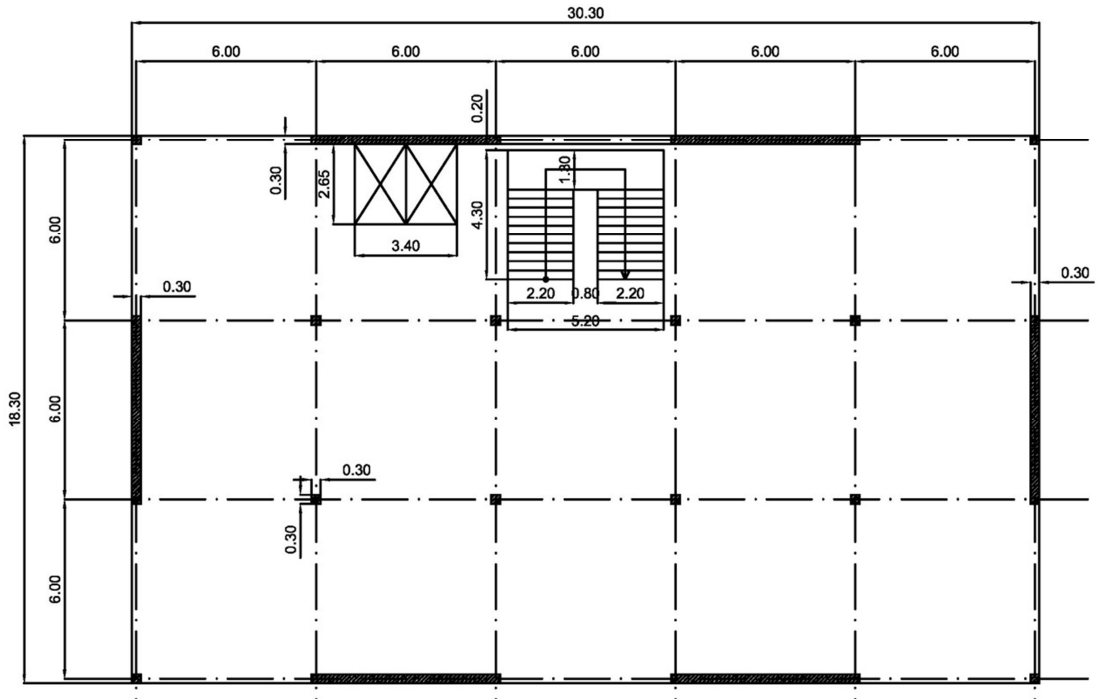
Grundriss Gebäudemodell 01
